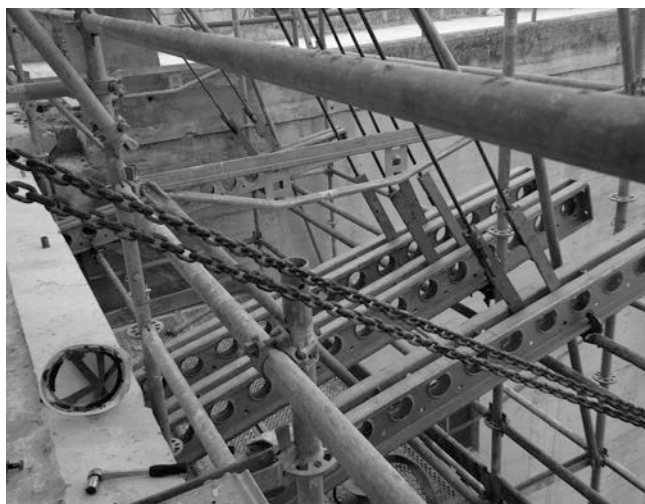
Ménsulas para soportar el encofrado del ensanche del tablero
